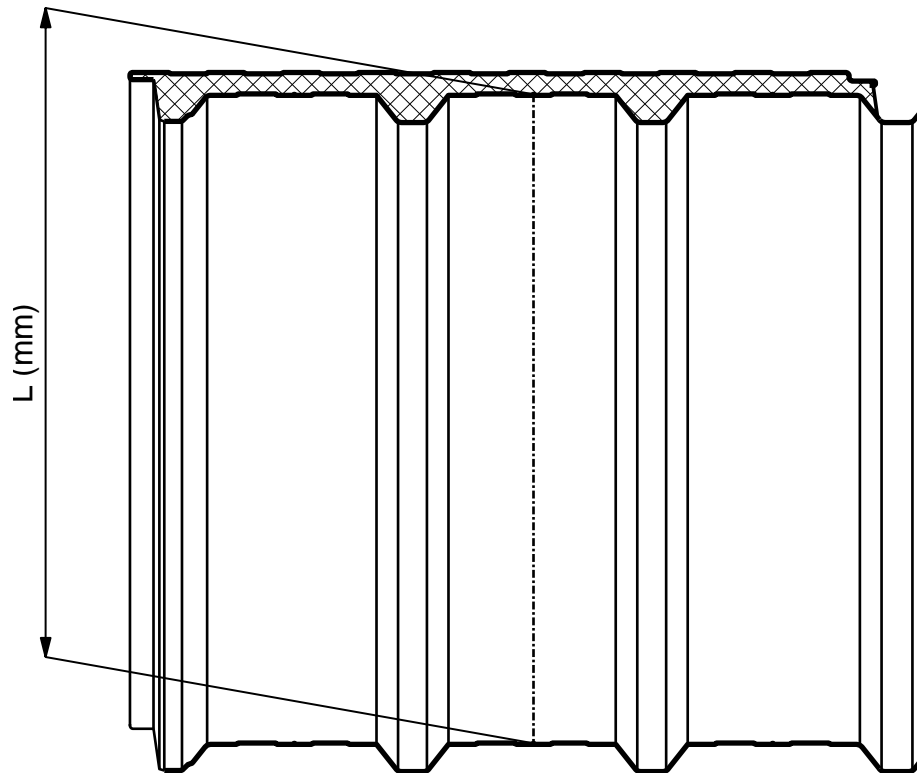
Longueur (mesurage sur un panneau de couverture, à la vallée centrale)
